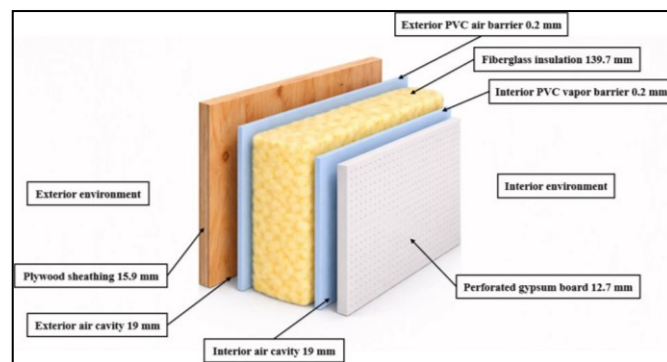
Assemblage mural multicouche extérieur de référence (Québec) [5, 6]
